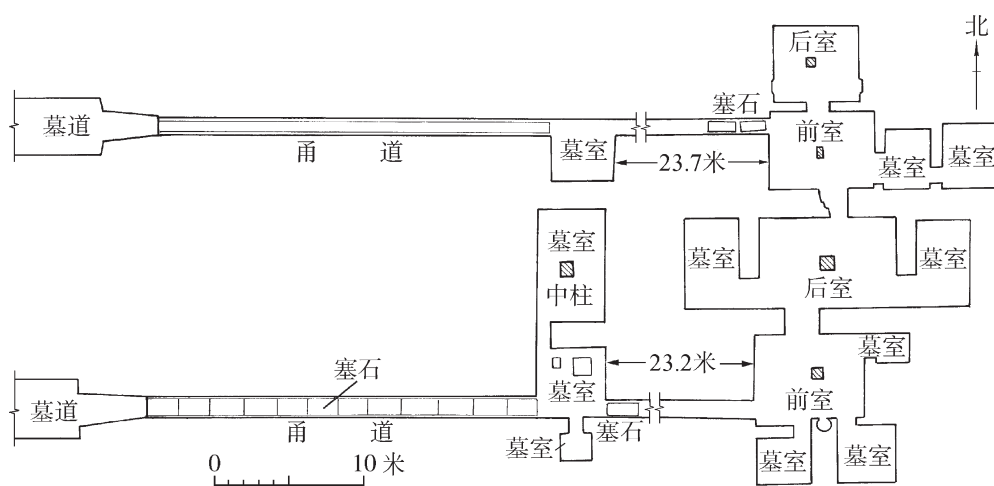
江蘇省徐州市龜山 2 号漢墓平面图 (1/500)
